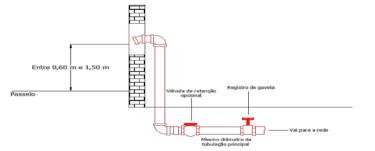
Hidrante de recalque na fachada ou muro da divisa
